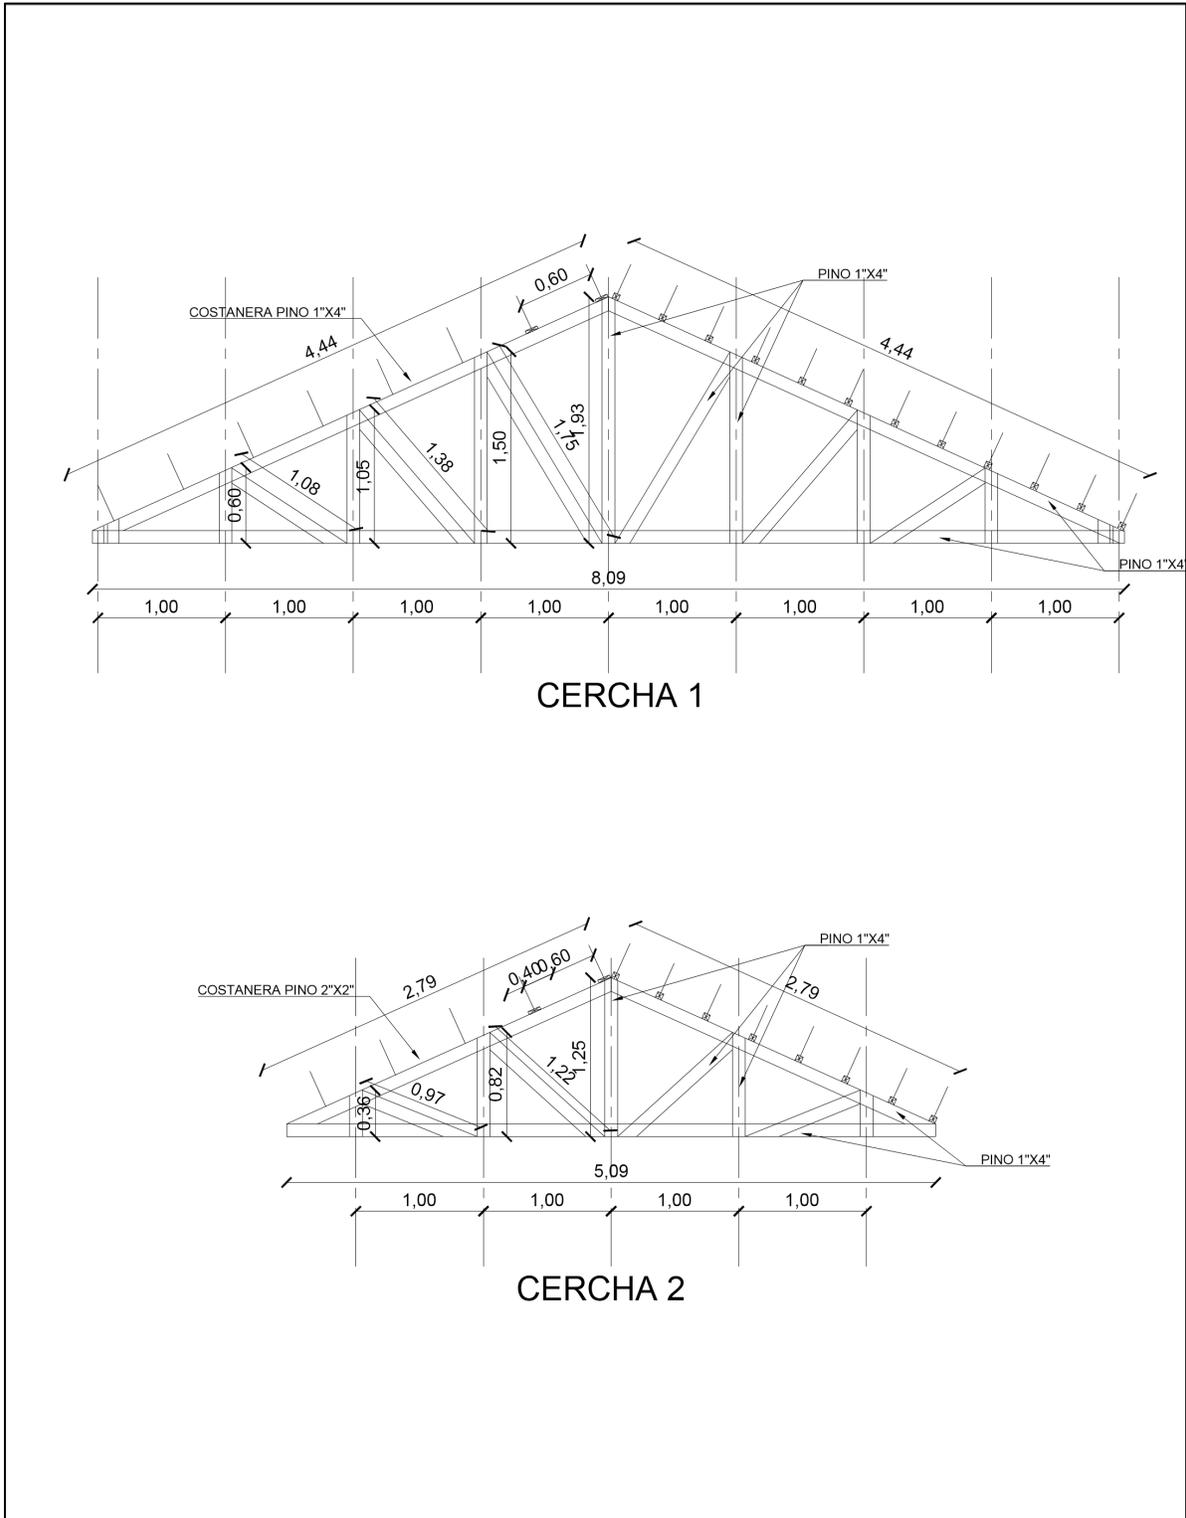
Elevaciones de estructura de techumbre modelo entramado de madera 2x4"
